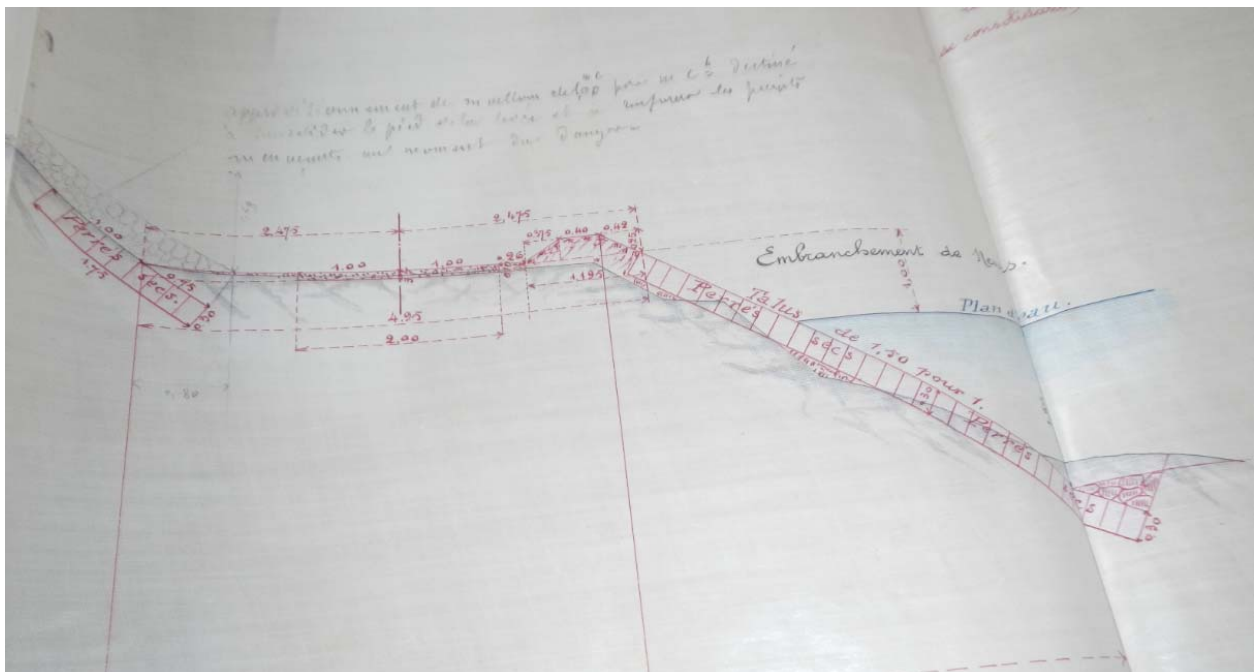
Profil type de la levée du canal de la Jonction avant et après travaux d'exhaussement et de consolidation exécutés côté val entre 1879 et 1882 – Source : Archives DDT 58
